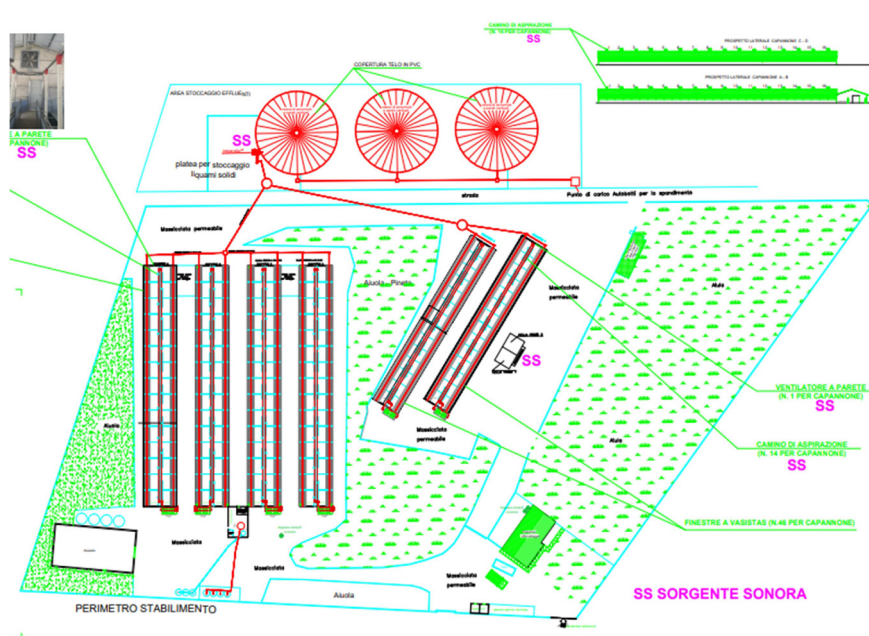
Elaborato Tav. 2 REV. 15.06.2020 – Planimetria generale stato di progetto
